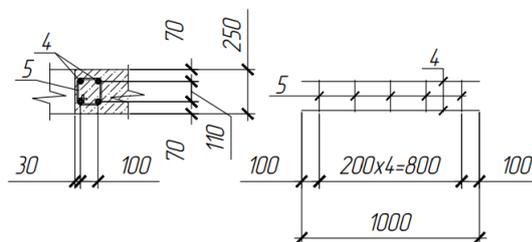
Схема каркаса К2 для усиления отверстий вентиляционных каналов
